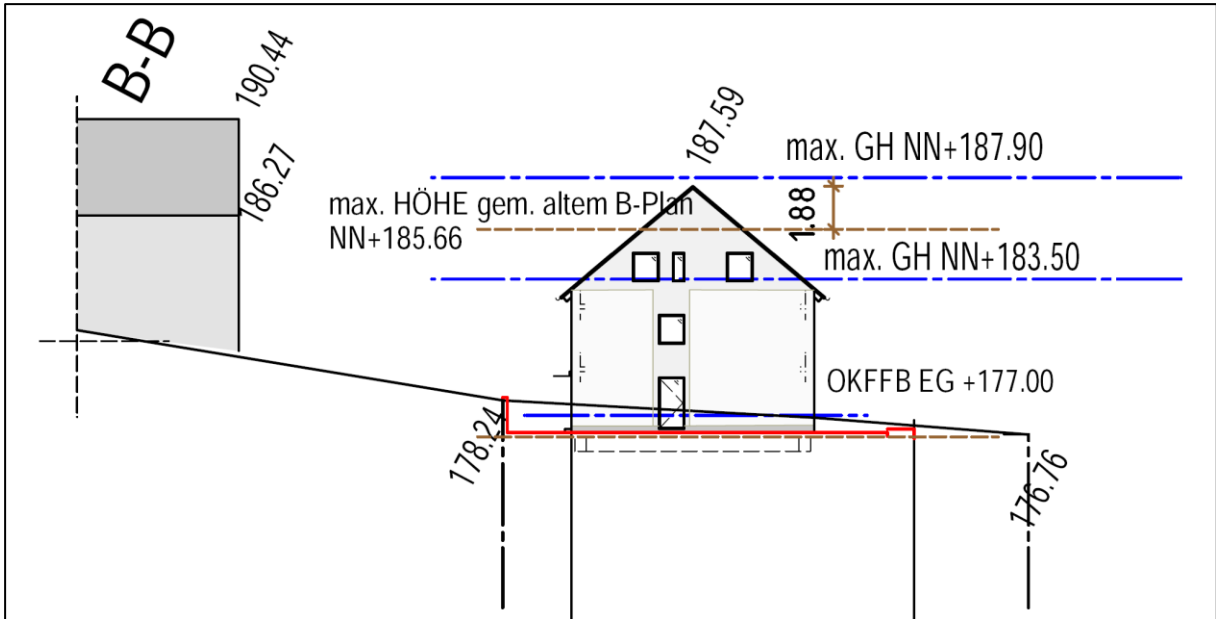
Schnitt B-B' zum Bestandsgebäude Kreuznacher Straße 14a (Flur 4, Flurstück 62/1)
